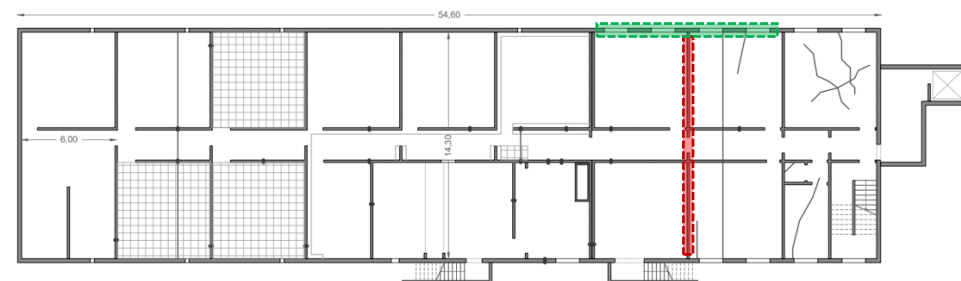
Bâti 13 - Plan de principe du sous-sol localisant les DDC estimée au droit d'un refend (en rouge) et d'une façade (en vert)
